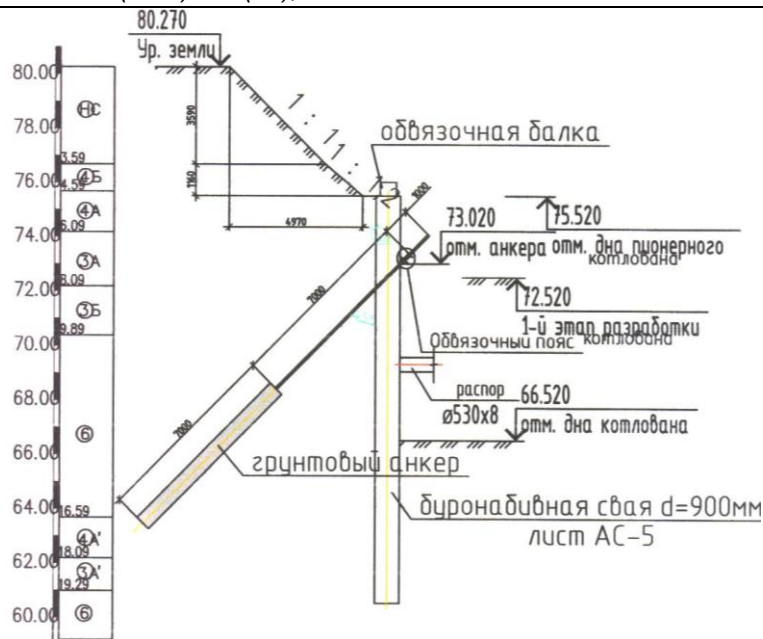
Конструктивная схема ограждения глубокого котлована системы «Стена в грунте», выполненной из одного ряда БНС с грунтовыми анкерами
